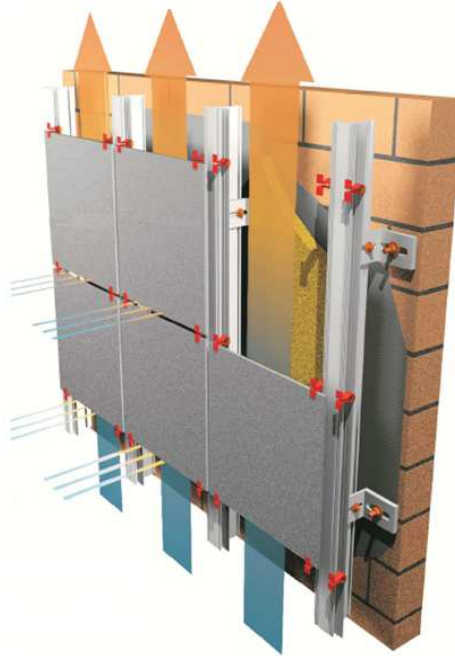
Ventilação natural nas fachadas ventiladas
